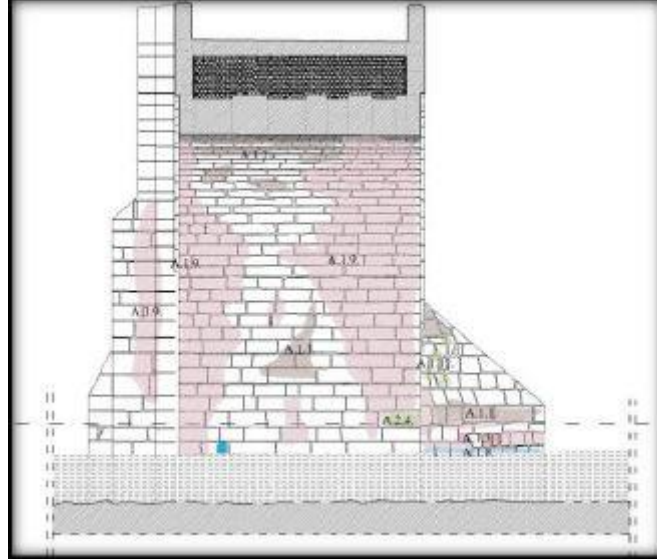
Murat Köprüsü Genel Görünüşü
